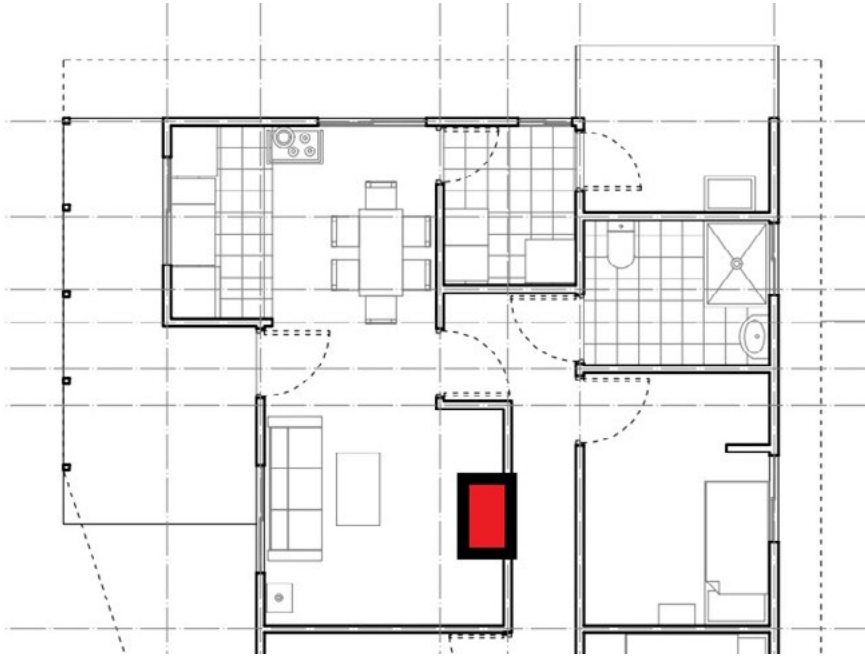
Planta de arquitectura sin escala de la unidad tipo. Fuente: elaboración propia.
